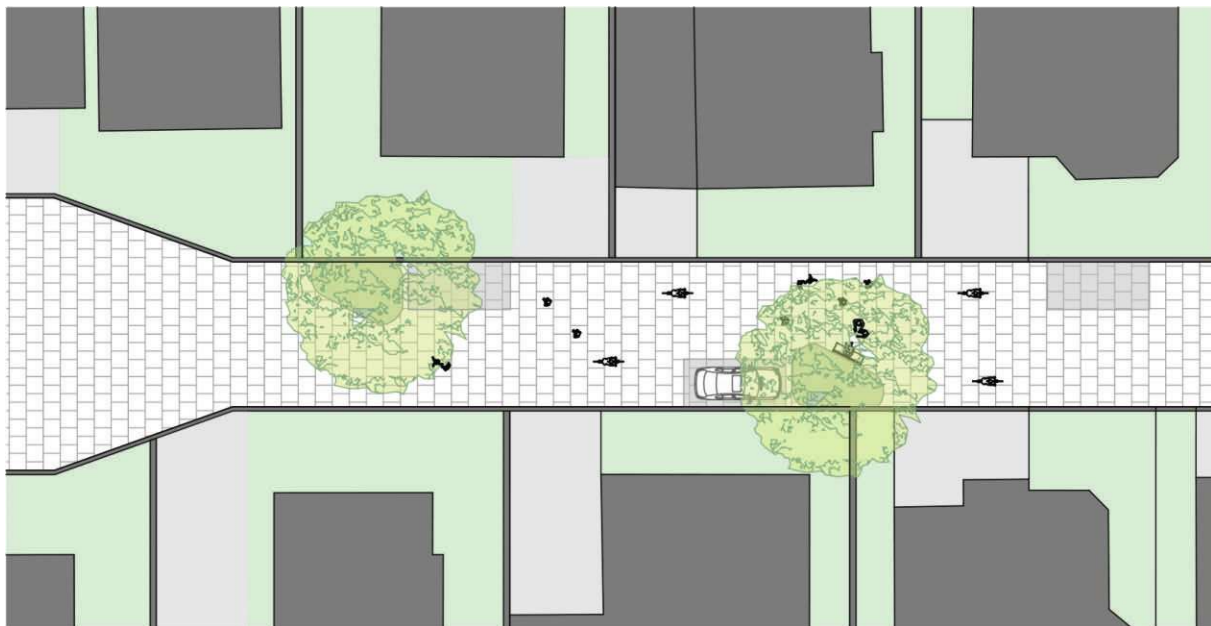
Grundriss Wohngebiet, eigene Darstellung
